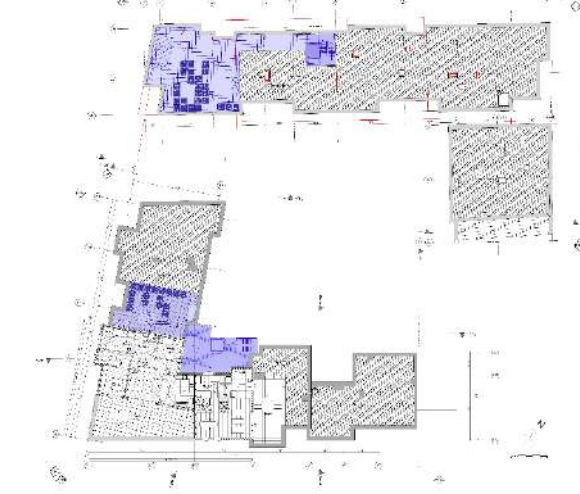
En bleu emplacement des toitures potagères (fond de plan issu de ADRIANA, annotations personnelles)
